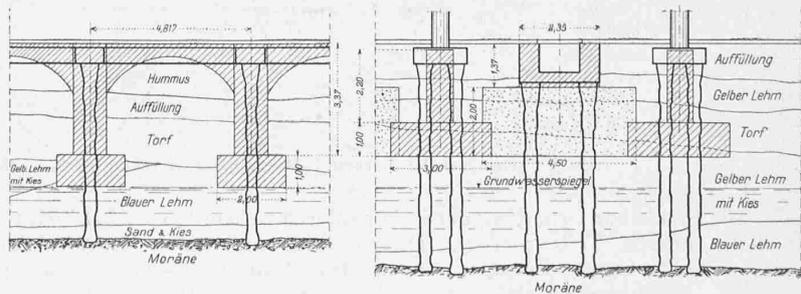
Vergleich der ursprünglich vorgesehenen Fundation (schraffiert) mit der ausgeführten Strausspfahlgründung. — Masstab 1 : 200.
